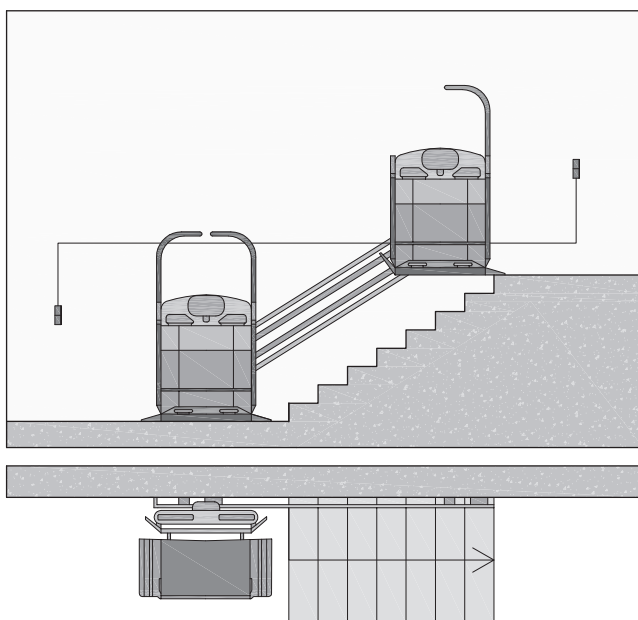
Vista en planta y alzado de una plataforma salvaescaleras.
